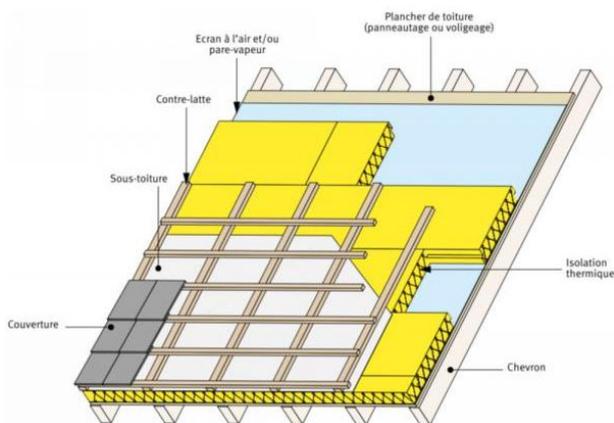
dispositif d'une toiture inclinée de l'extérieur
